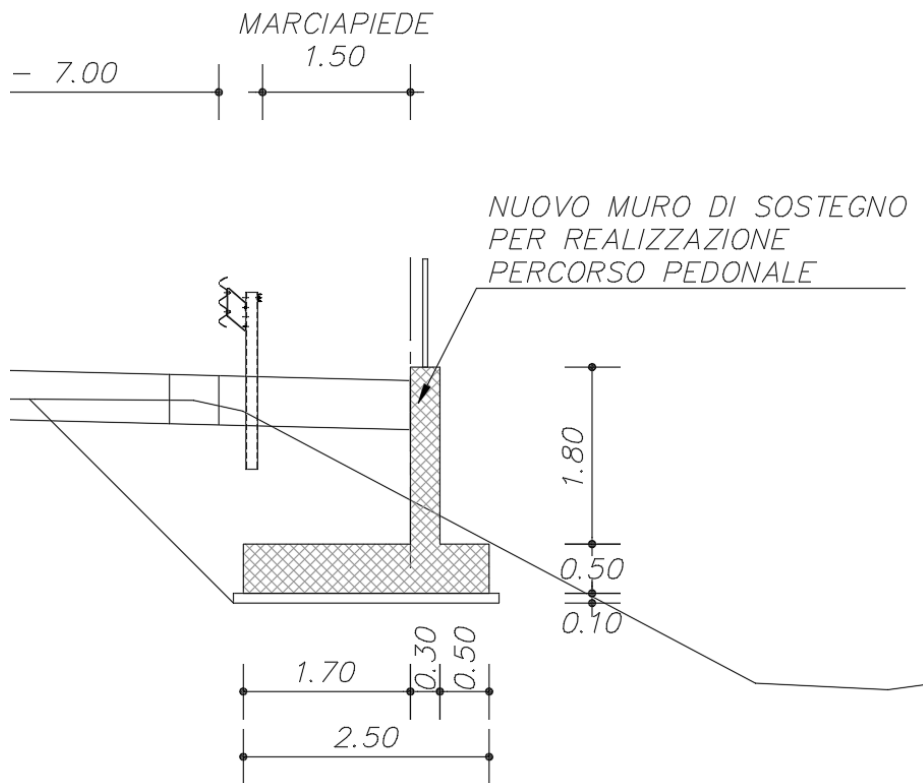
Sezione B (muro  $h \leq 180$  cm)
